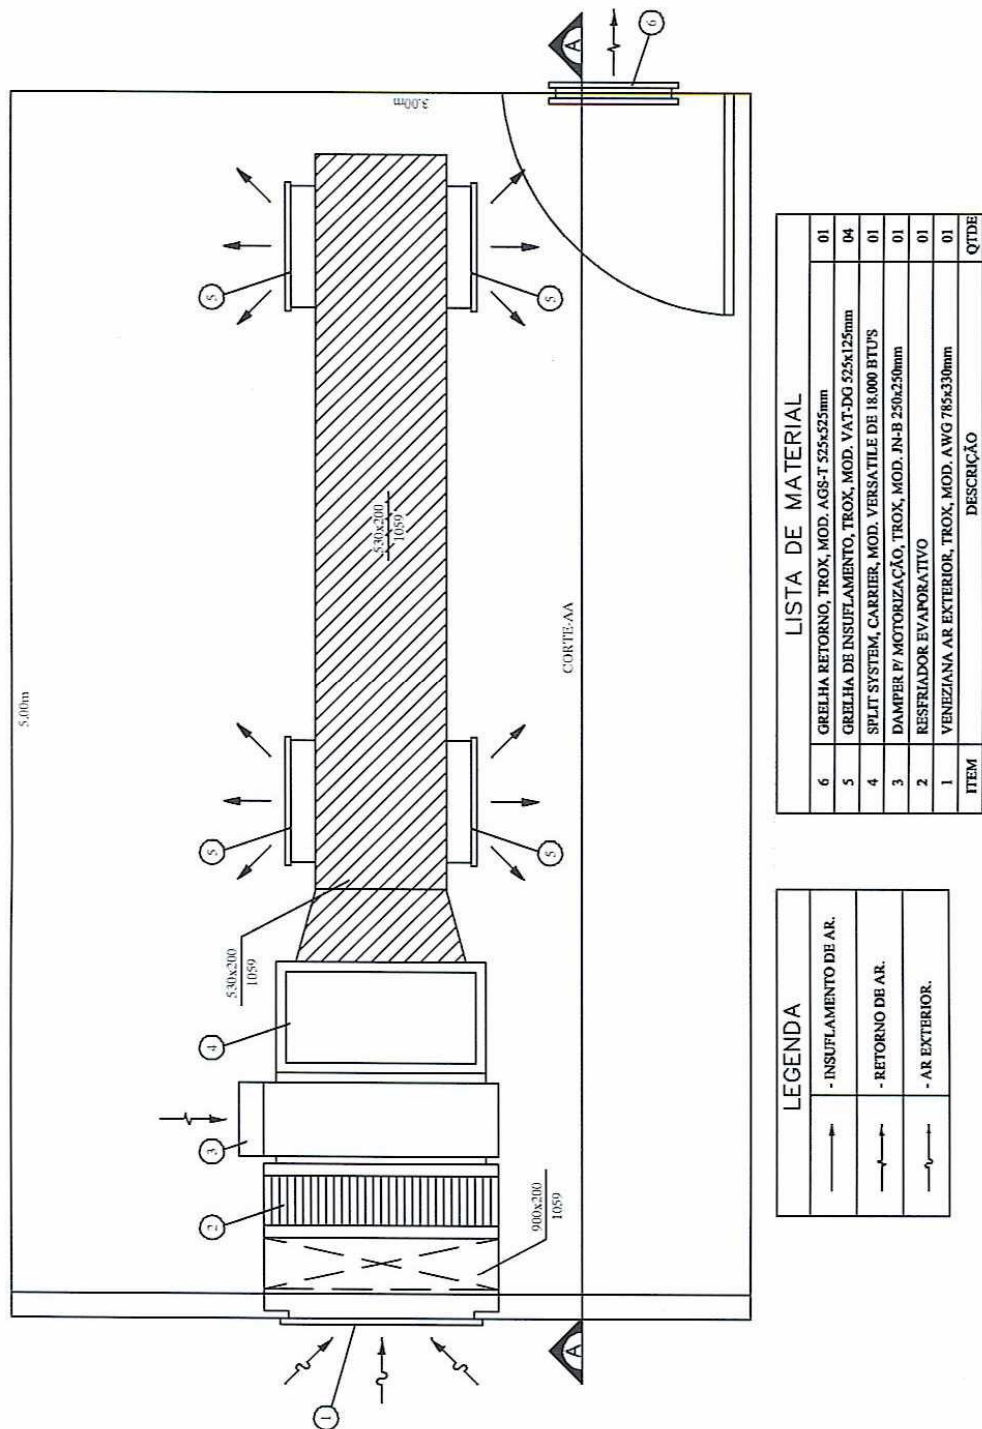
Projeto do sistema híbrido (planta baixa).
